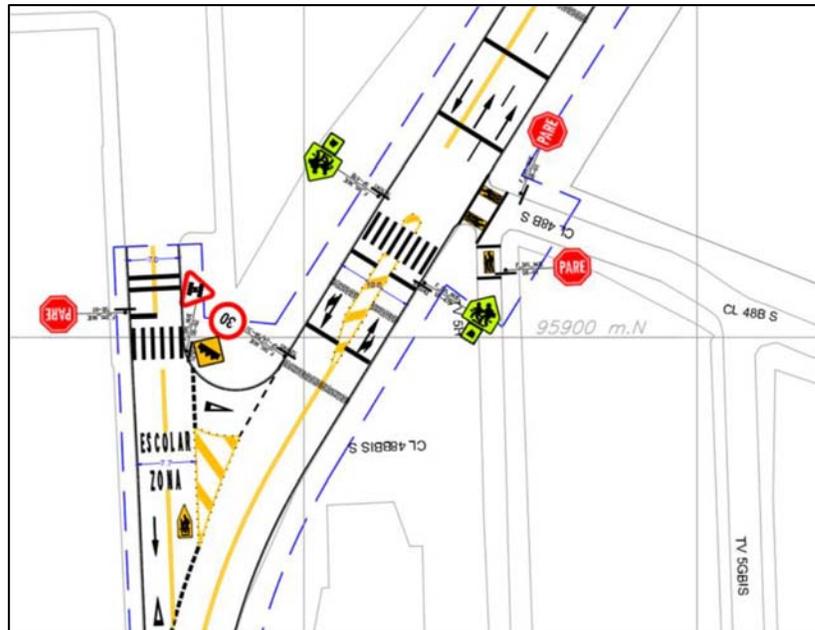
Transversal 5H con Diagonal 45 Sur
